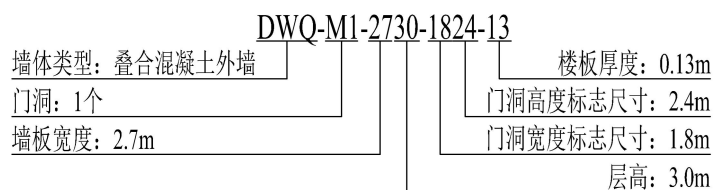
一个门洞叠合混凝土外墙编号规则示意图
